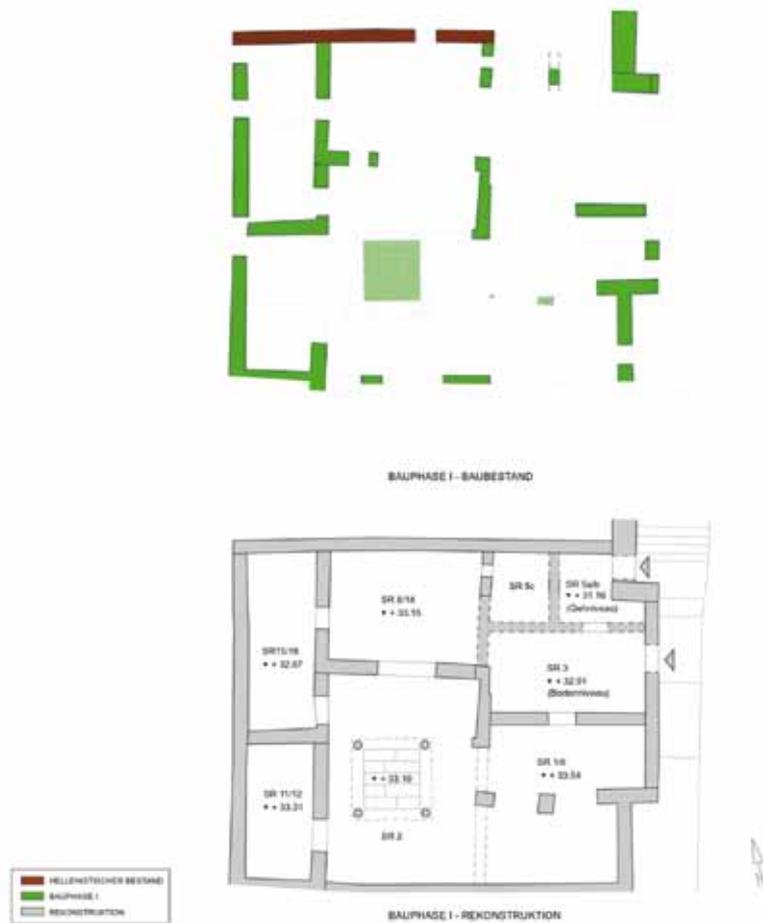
Hanghaus 2, WE 1, Grundriss Bauphase I
